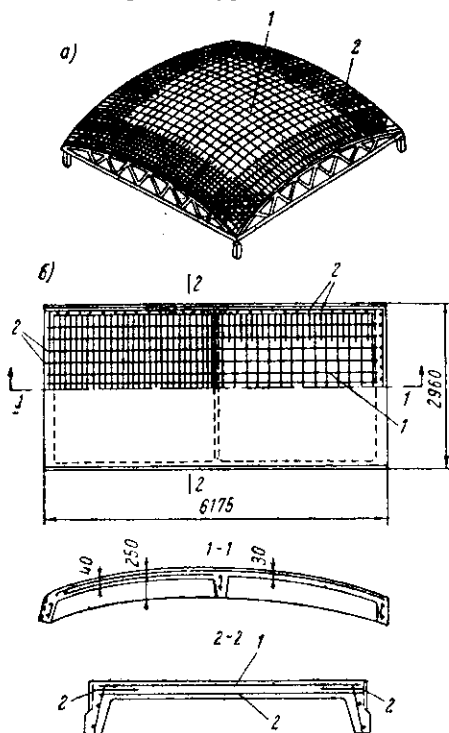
Конструирование выпуклых квадратных в плане оболочек
